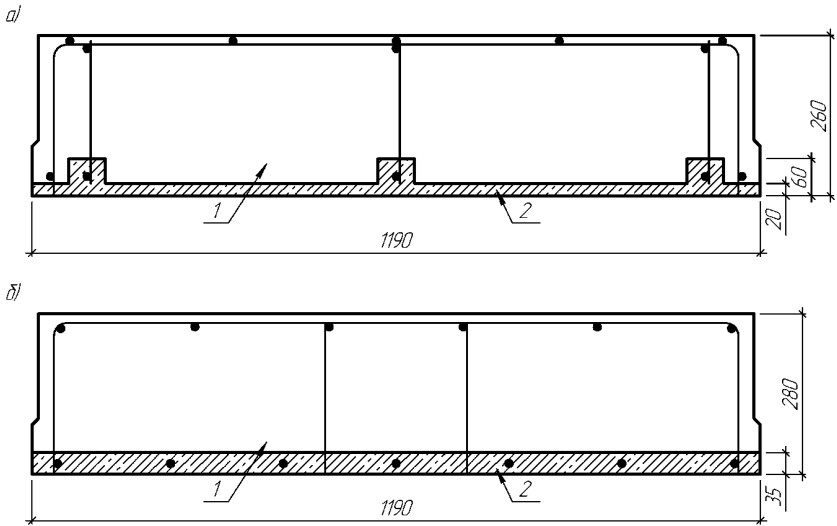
Плити для горіщних перекриттів з попередньо напруженою арматурою:
